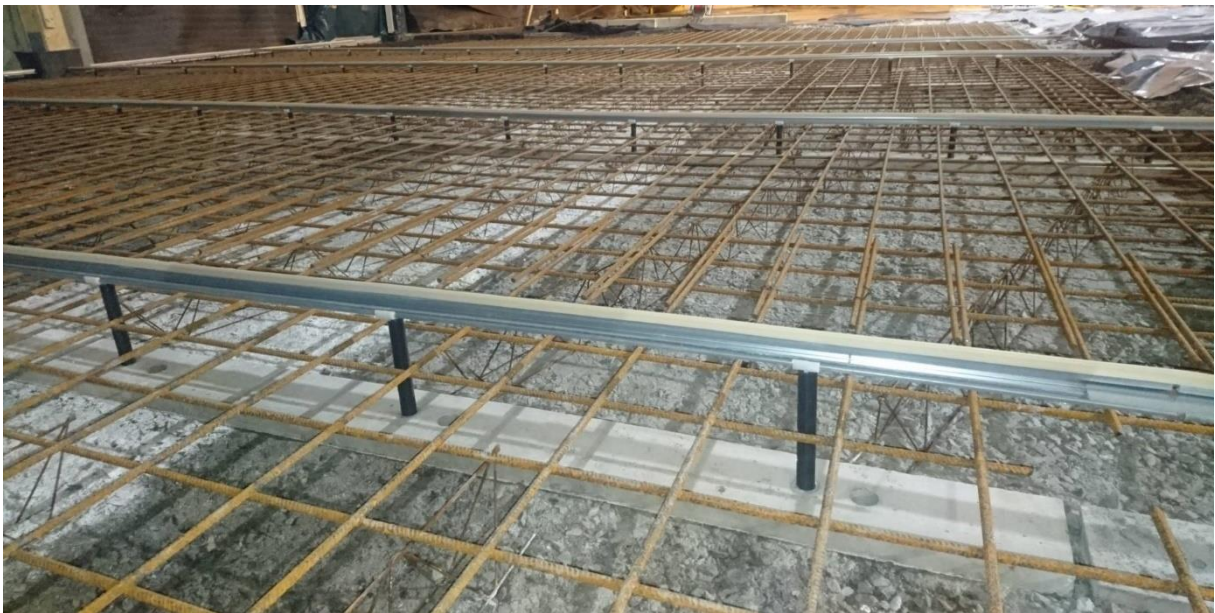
Plåtbanan alt betongbanan fästes i hållaren.
